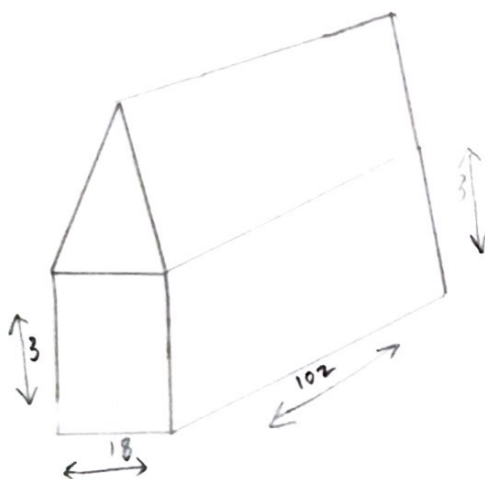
Схематическое изображение здания для расчета площади ограждающих конструкций
